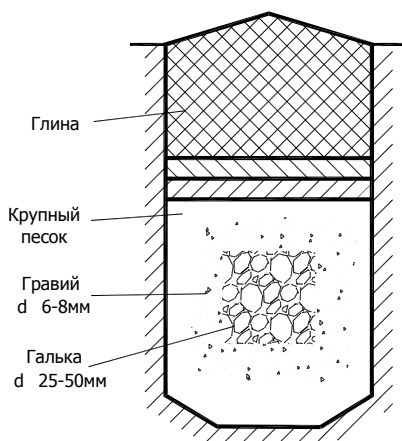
Схема понижения уровня грунтовых вод посредством горизонтального дренажа
